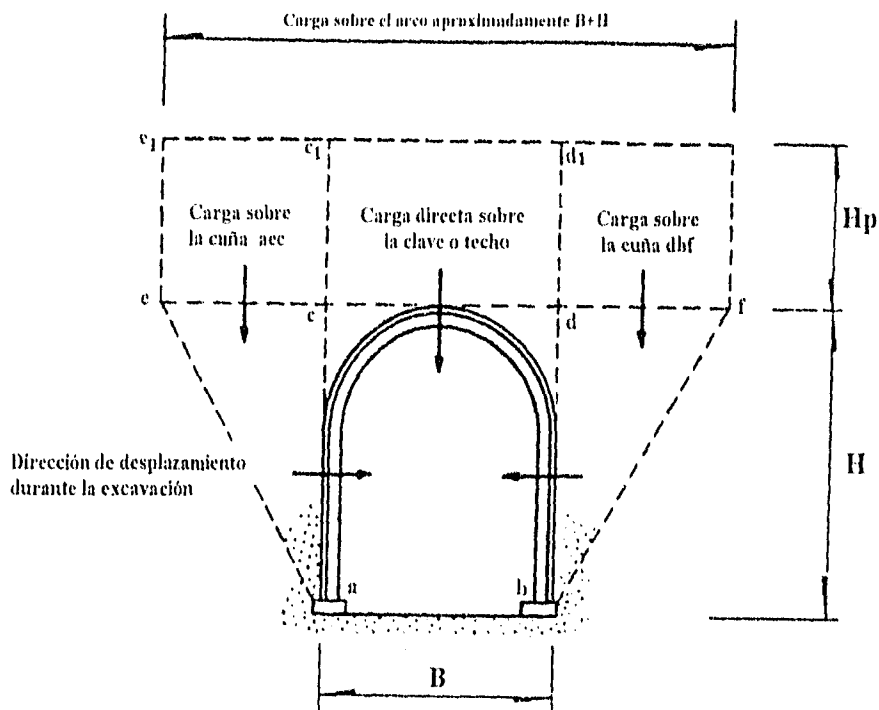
Cargas sobre un túnel excavado en arenas
